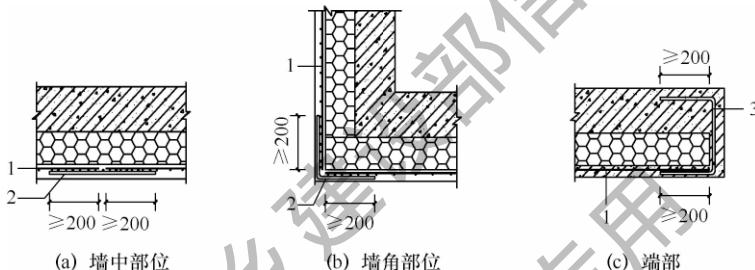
防护层钢筋焊接网水平搭接
